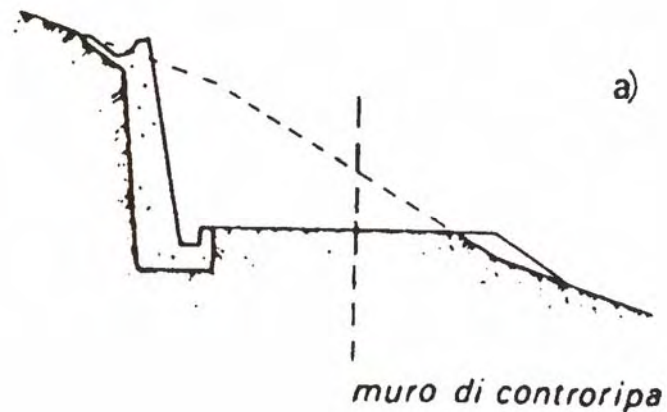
Costruzione di muro di sostegno per sezione stradale in trincea
